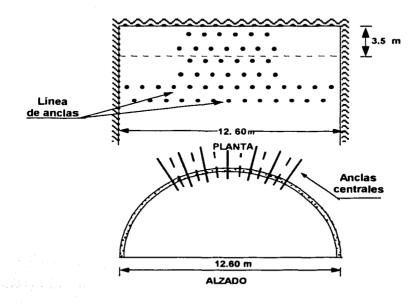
anclaje central, elementos de 1" \oslash x 4.2 m
